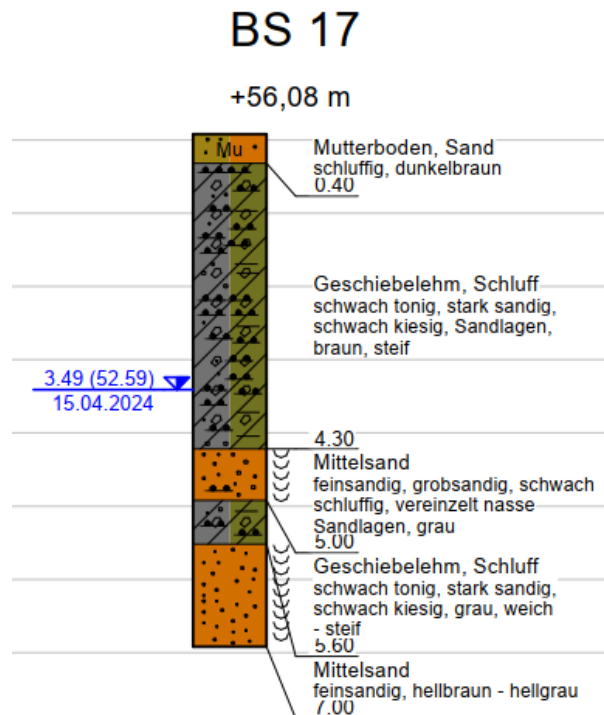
Ausschnitt aus dem Baugrundgutachten. Profil BS 17 (Quelle: Büro GBU 04/2023)
